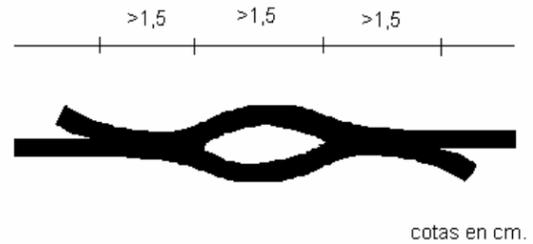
Dimensiones mínimas de la soldadura doble.
